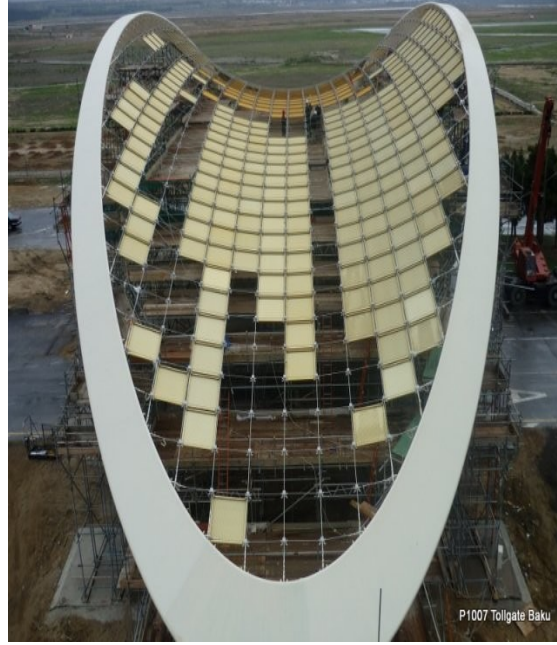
Haydar Aliyev Havaalanı giriş kapısı ön görünüm (solidbau/1, bt)
